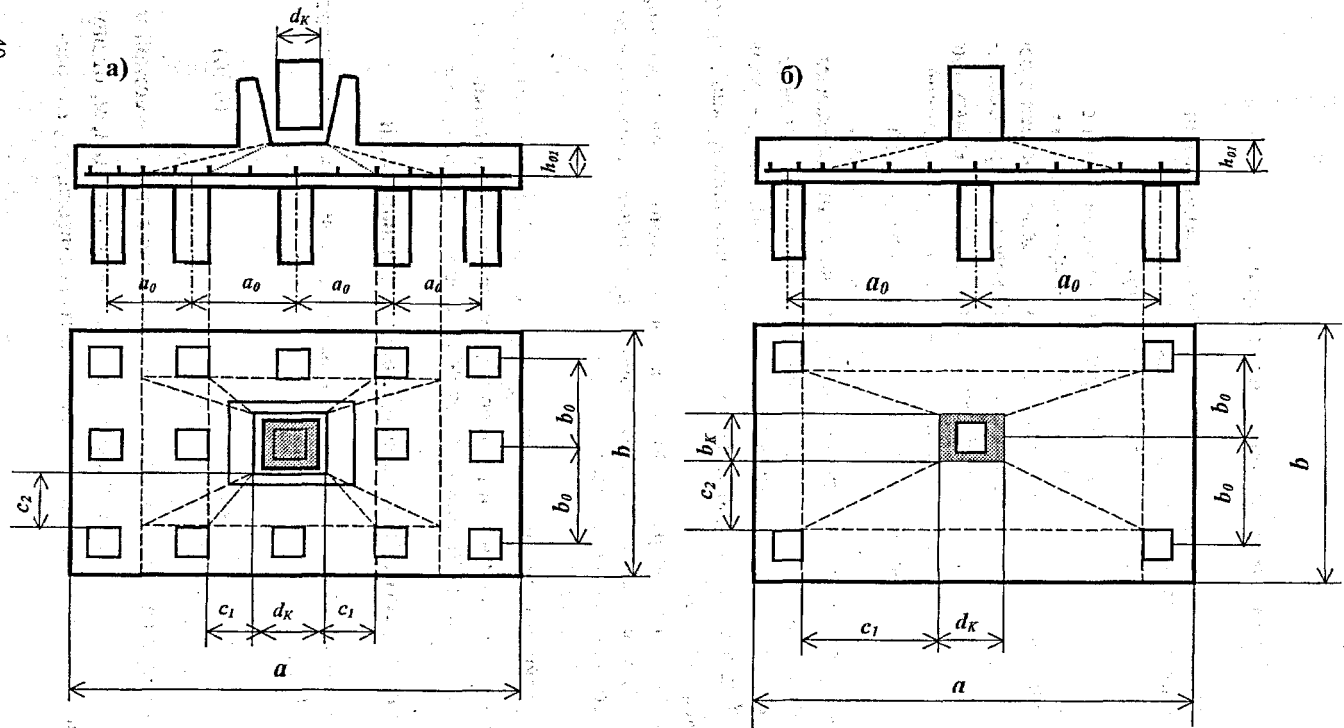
Схема образования пирамиды продавливания в ростверке под сборной железобетонной колонной при многорядном расположении свай за наружными границами колонны (а) и монолитной железобетонной колонной (б)
